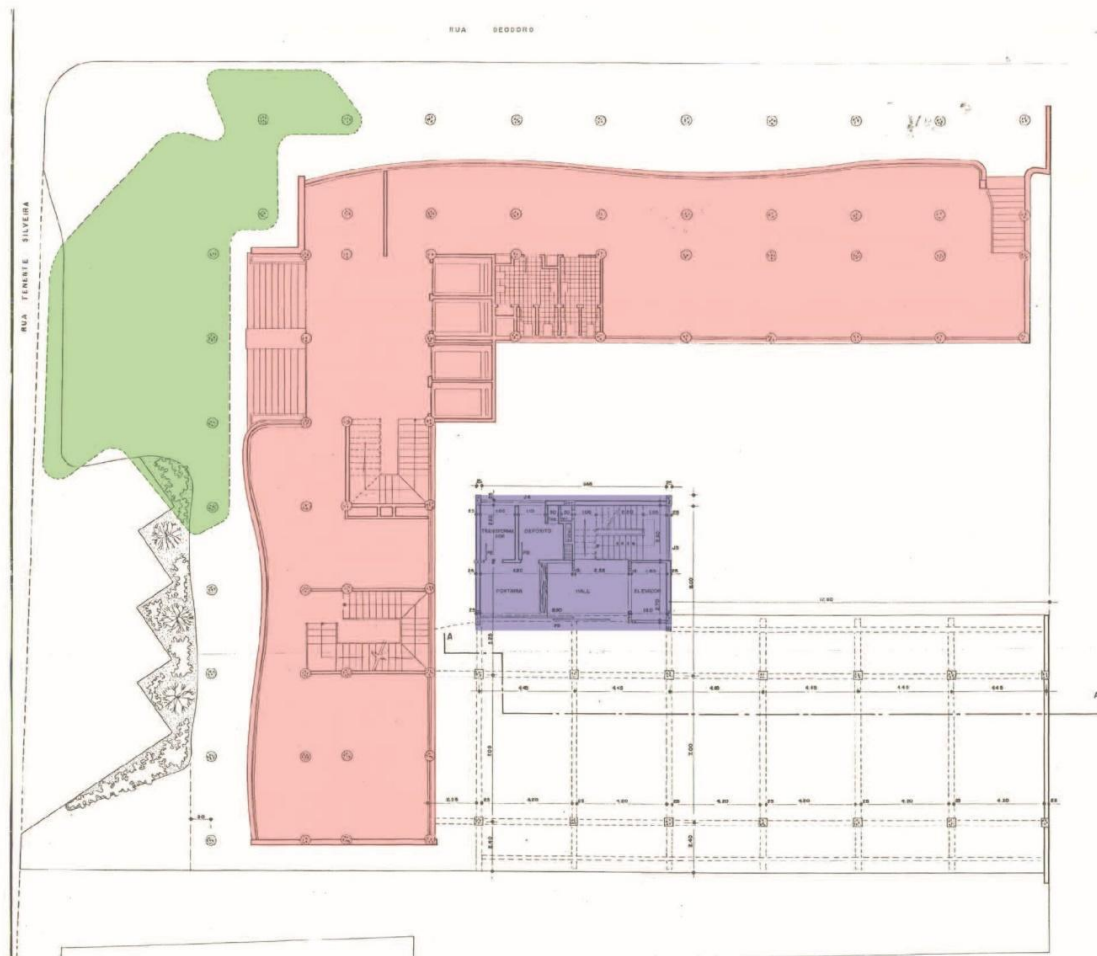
Planta baixa, em verde marquise curvilínea, em rosa planta livre e em cinza uma previsão de ampliação para colocar escada enclausurada. Fonte: Arquivos DAE Departamento autônomo de edificações, estado de Santa Catarina – secretaria dos transportes e obra. Projeto de ampliação (não executado, em roxo), agosto de 1976.
